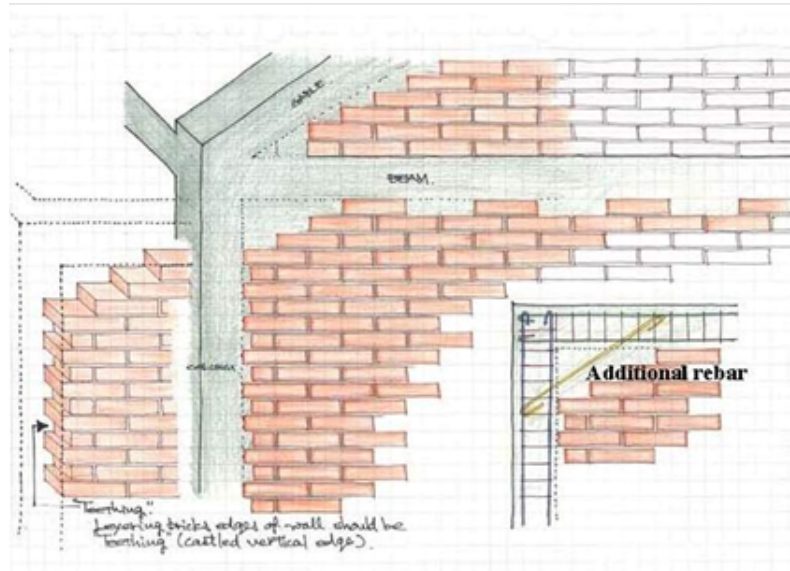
Recreido de la unión pilar-cadena (Narafu, 2008)
